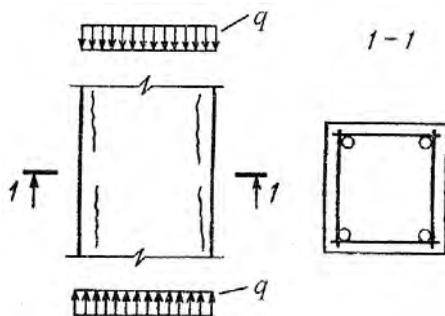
Трещины вдоль продольной арматуры в сжатых элементах
